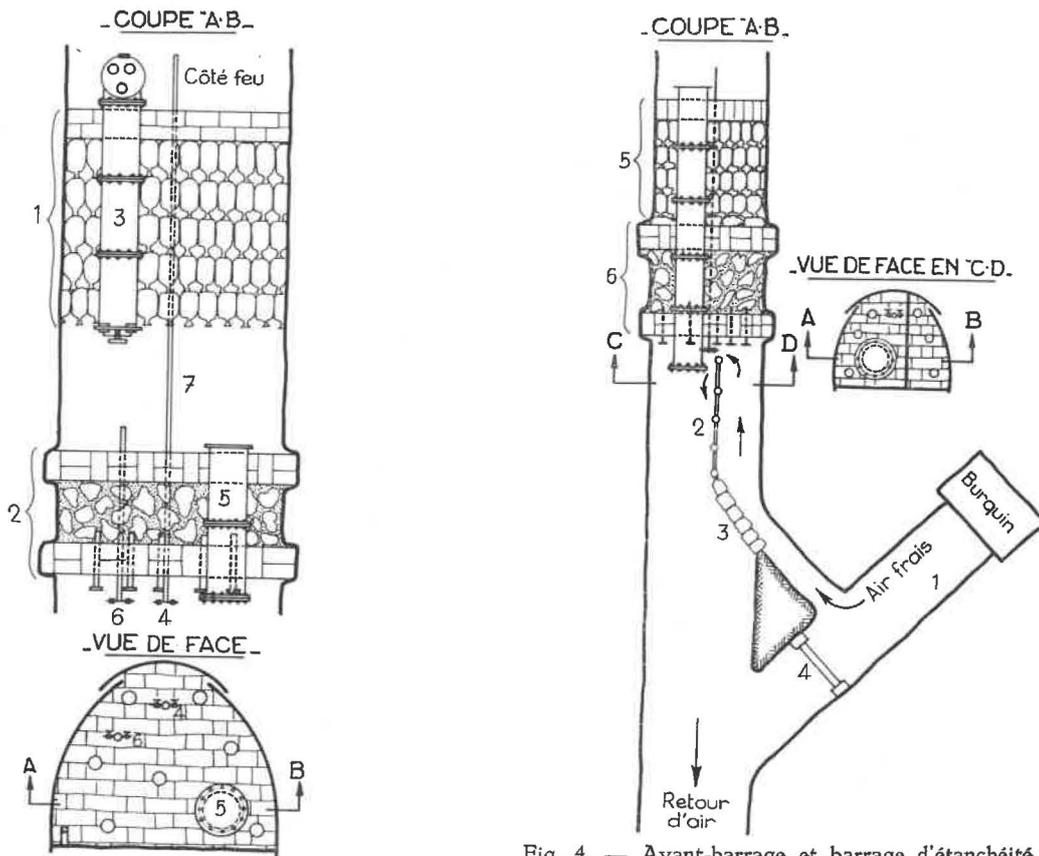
Avant-barrage et barrage d'étanchéité. — Cas des chantiers grisouteux. Retour d'air. Atmosphère à température élevée. L'avant-barrage de choc a été fermé avant la construction du barrage d'étanchéité.
